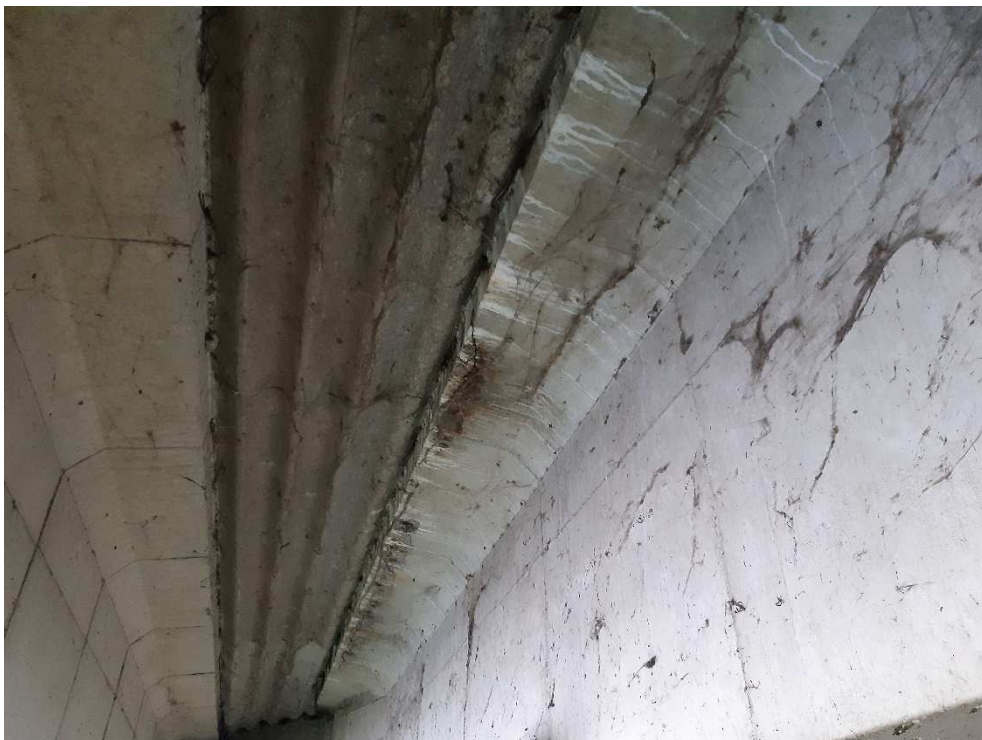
pt5- traces de calcite, d'oxydation, fissure longitudinale généralisée sur la semelle supérieure – coté aval
